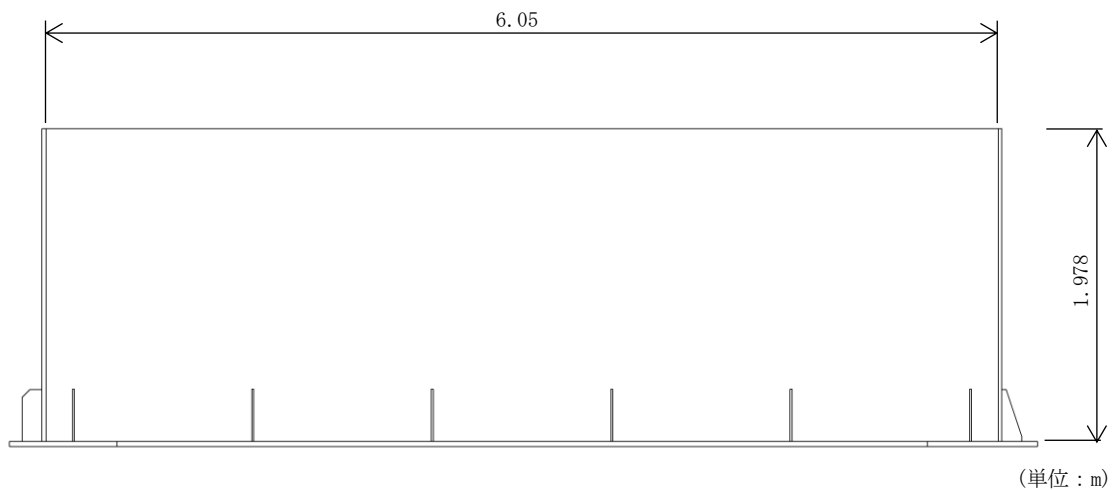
取水槽海水ポンプエリア防護対策設備の平面図
